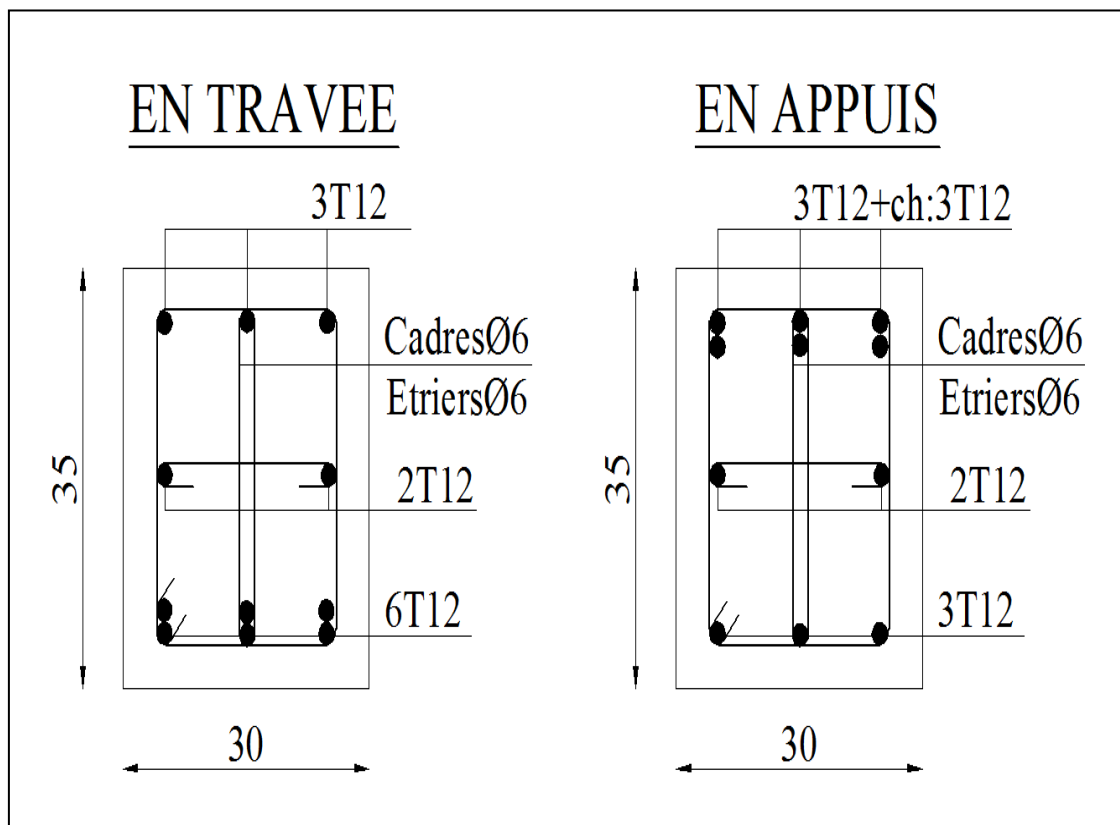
Ferraillage de la poutre palier (appuis et travée)
